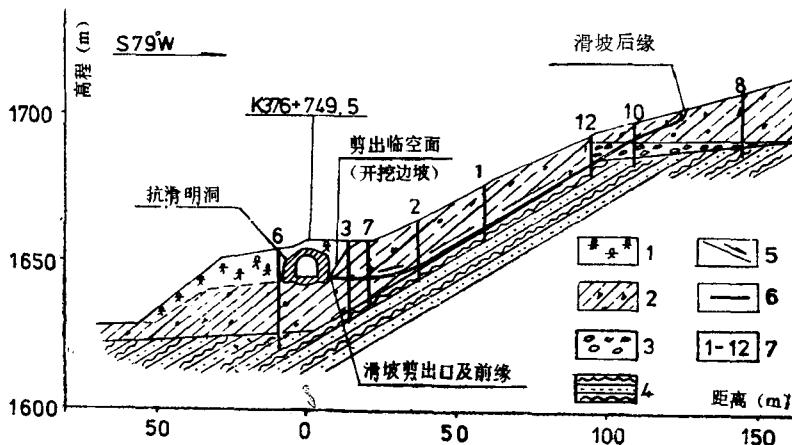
阿底滑坡主轴剖面图 (参考377滑坡工程地质断面图)
